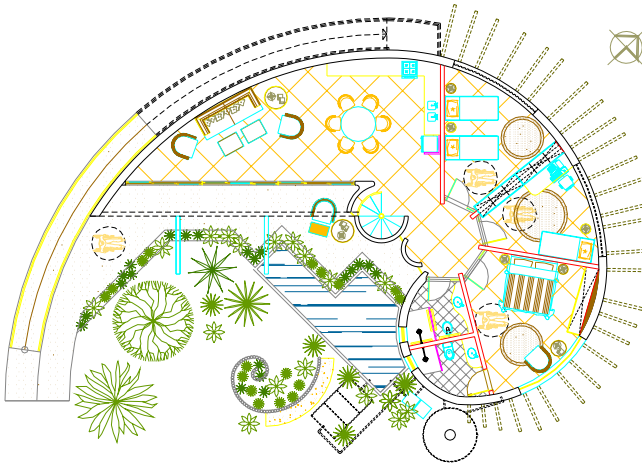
Planta da Habitação Tipo 01: 3 quartos
